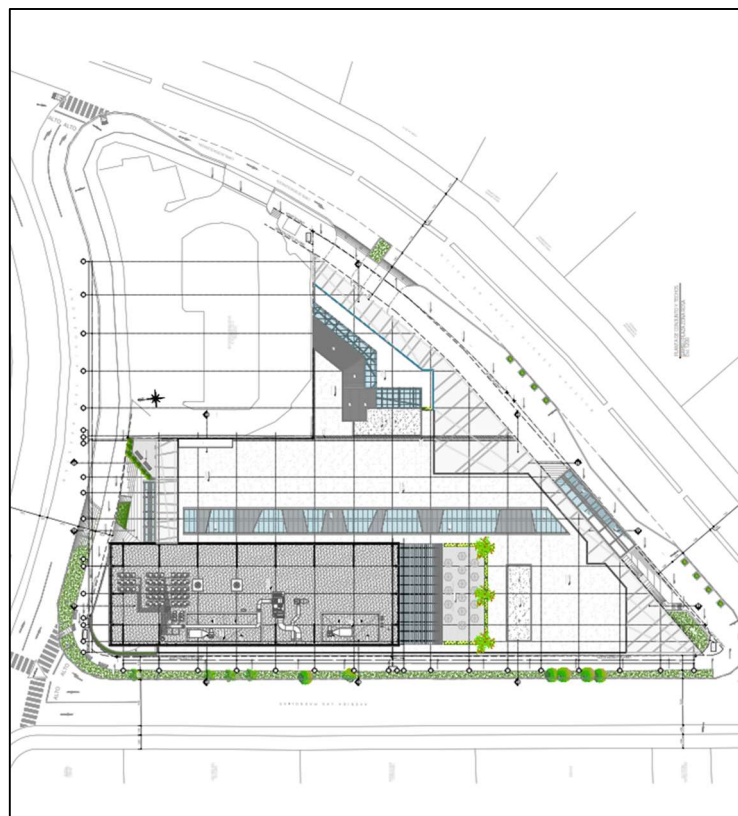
Planta de distribución edificio Centro Comercial Bambú. Fuente: Proporcionada por Centro Comercial Bambú.
